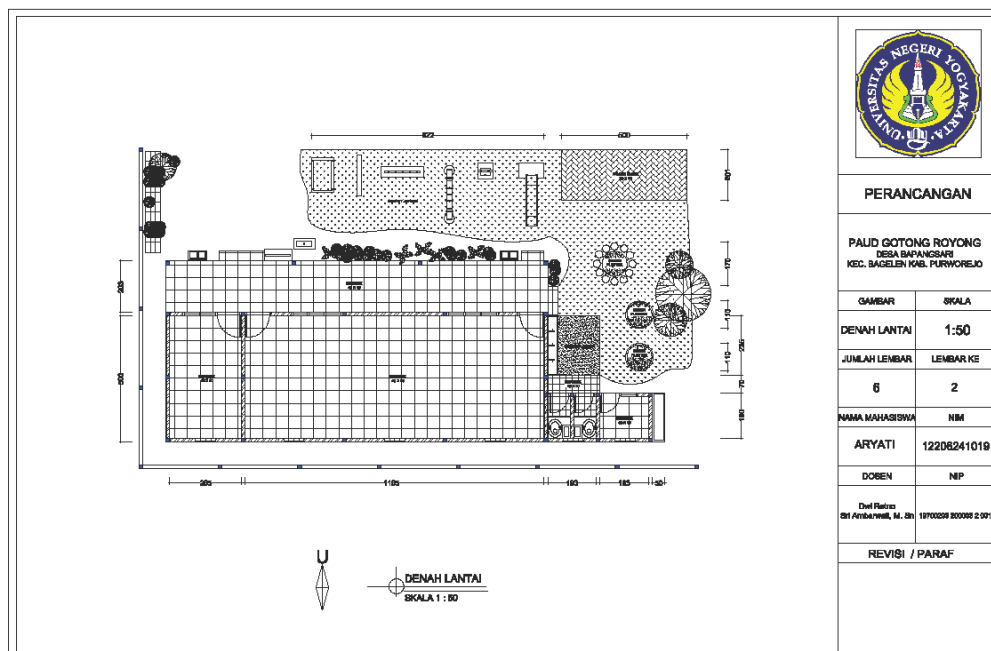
Denah Perancangan Ruang PAUD Sebelum Revisi
